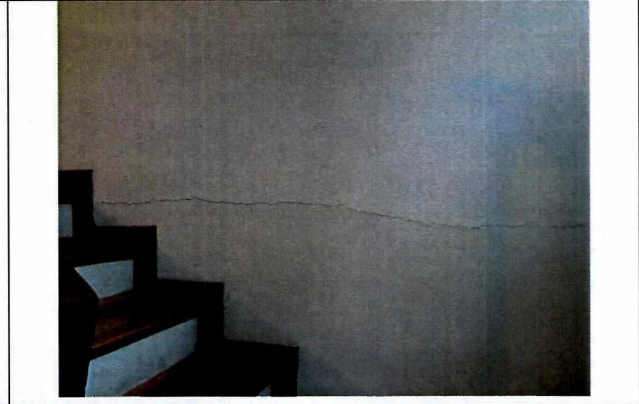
Fisura bajo escalera de acceso al segundo piso – 04 de febrero de 2019.
